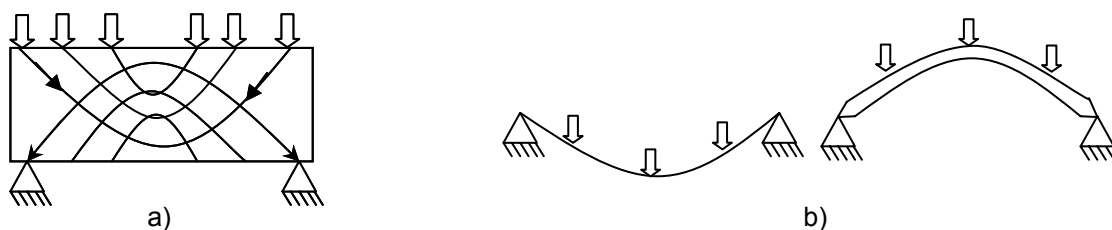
a) Principais tensões de uma barra, b) estrutura com cabo e em arco
